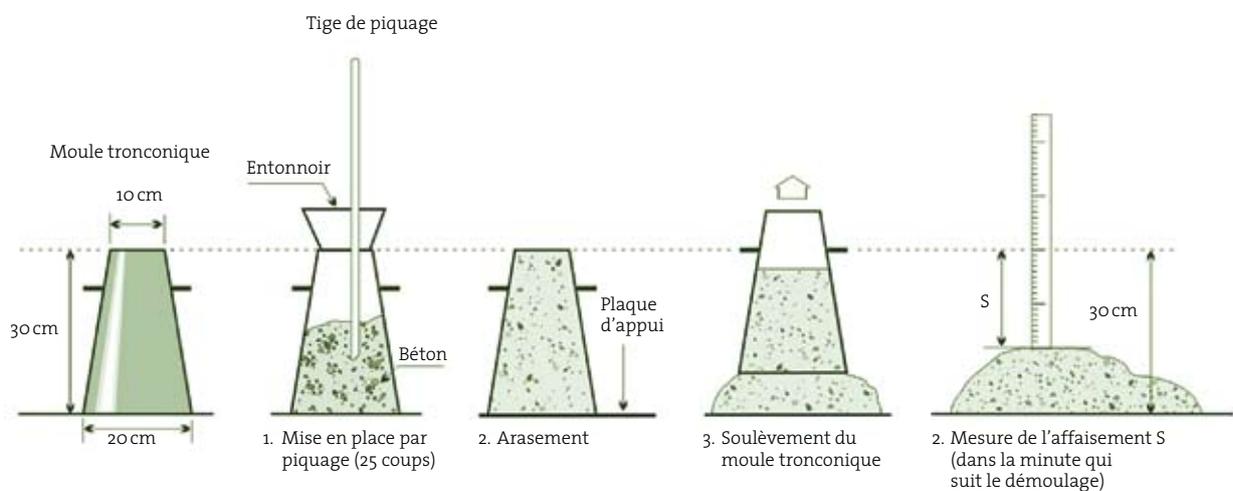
Essai d'affaissement au cône d'Abrams (slump)
